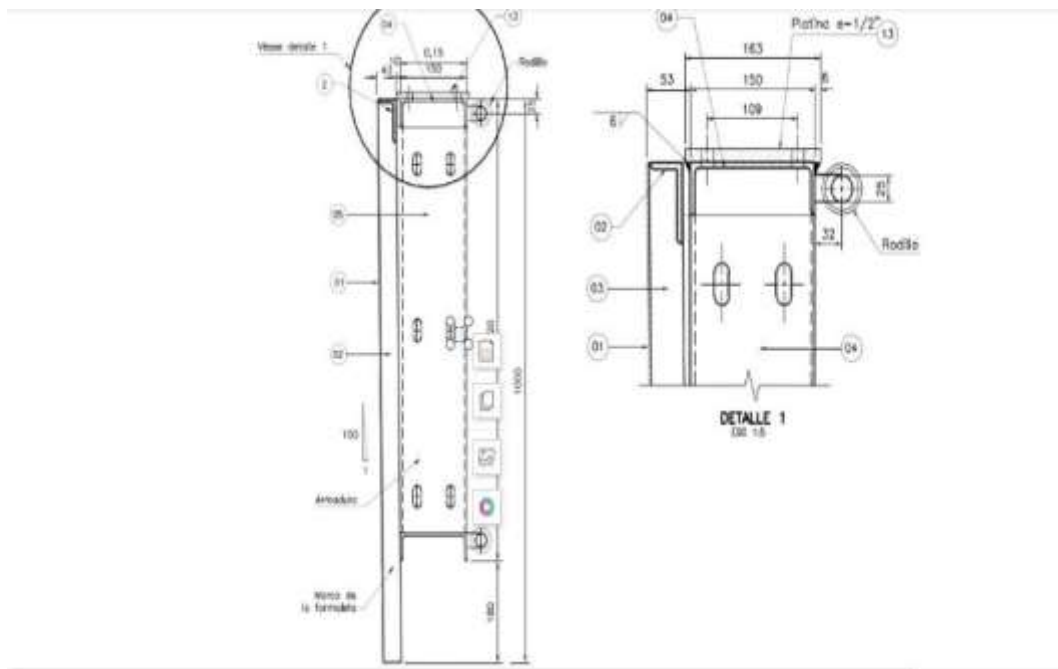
Tableros de la formaleta deslizante*Fuente: Plano interno PHI 102245 proyecto Hidroituango
